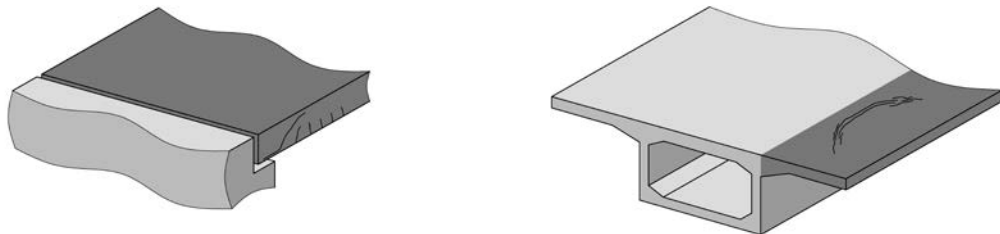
Querkraftgefährdete Brückentypen: (a) vorgespannte Plattenbalken- und Hohlkastenbrücken mit geringer Schubbewehrung vor 1989 erbaut (b) Plattenbrücke und Fahrbahnplatten in Querrichtung ohne Querkraftbewehrung vor 1968 erbaut
